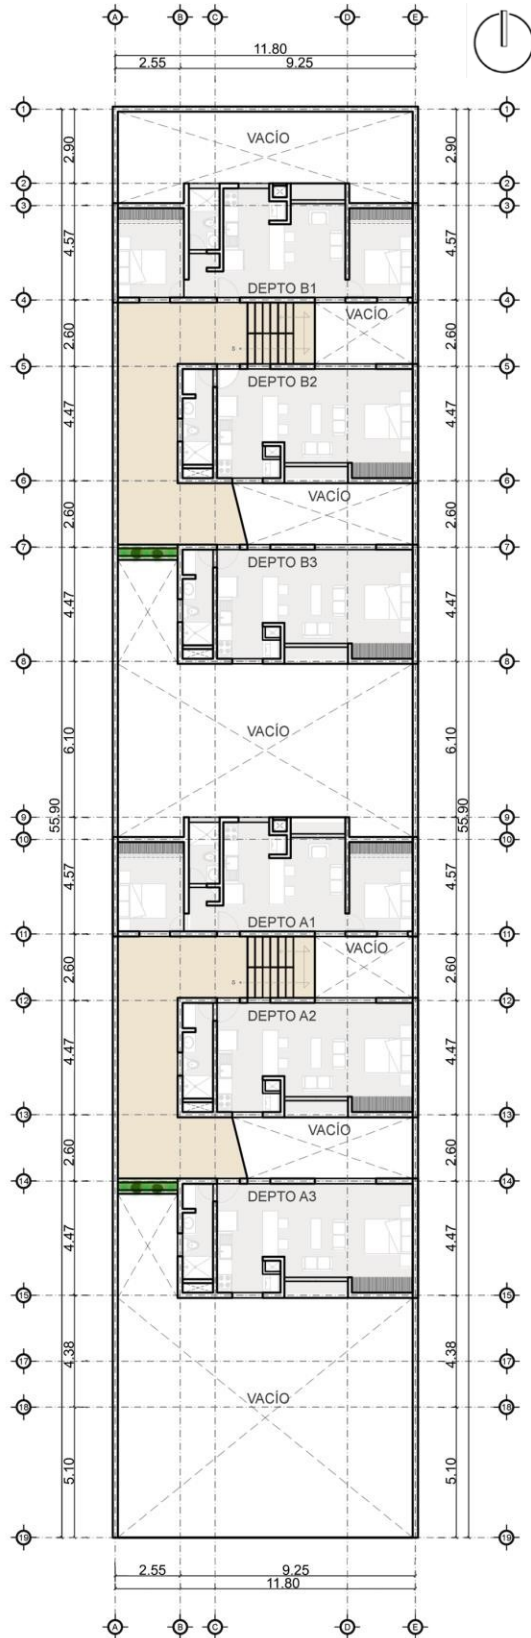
Planta Tipo Nivel 1 al 4, esquemática, Sin escala. Fuente: Elaboración propia.
